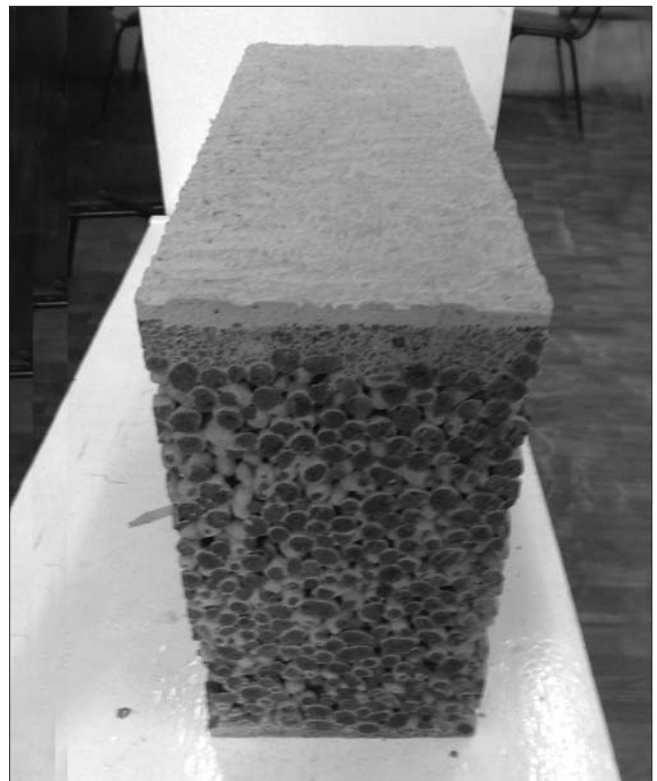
Фрагмент стенового блока из беспесчаного керамзитобетона
